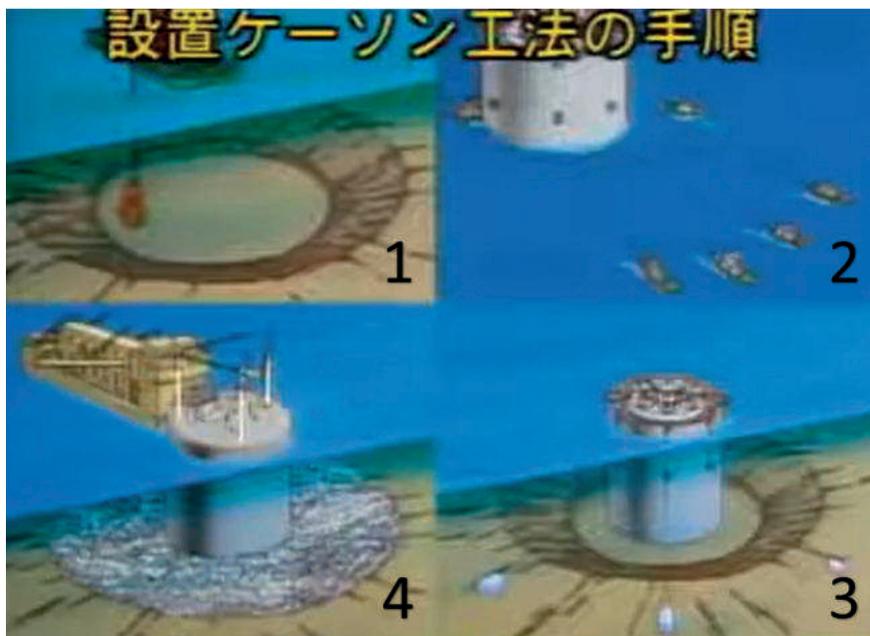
Schema di realizzazione delle fondamenta del ponte Akashi Kaikyo [43].
